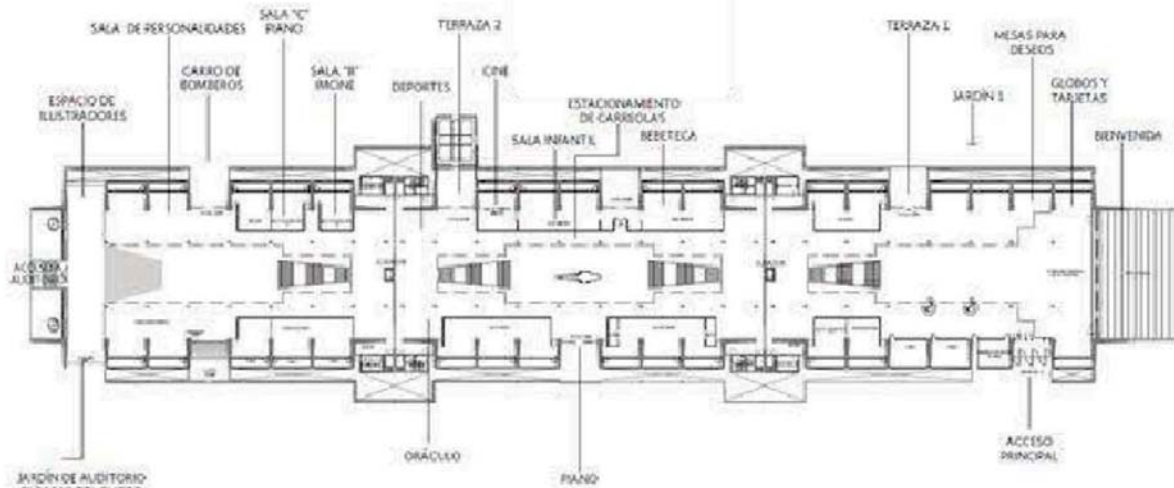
Alberto Kalach (2011), [Plano planta baja, Biblioteca Vasconcelos] Recuperado de <https://www.archdaily.mx>
